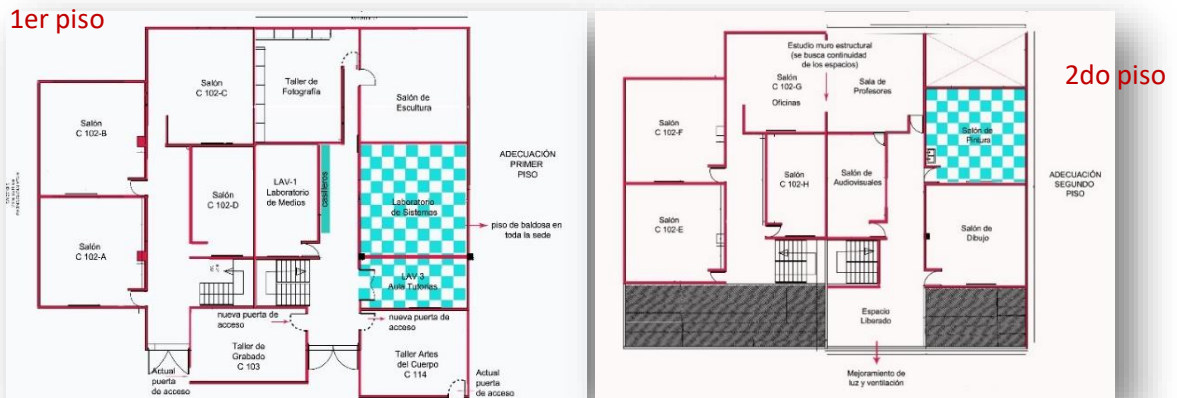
, plano primera y segunda planta, adecuación infraestructura de la LAV.
